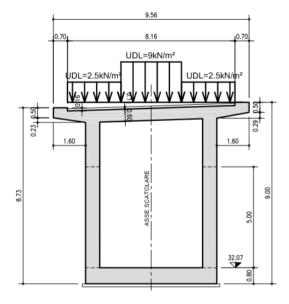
disposizione trasversale dei carichi tandem (4)
